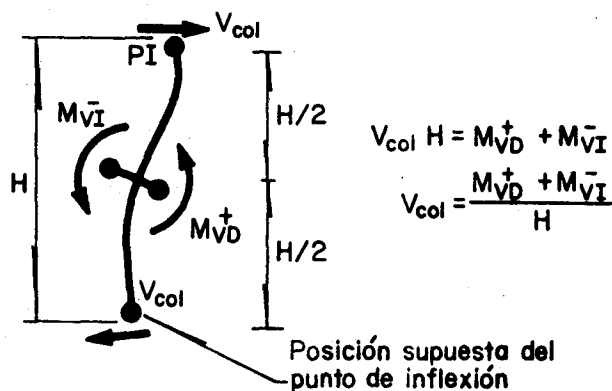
Fuerza cortante actuante en la columna, para el mecanismo de "columna fuerte-viga débil"
